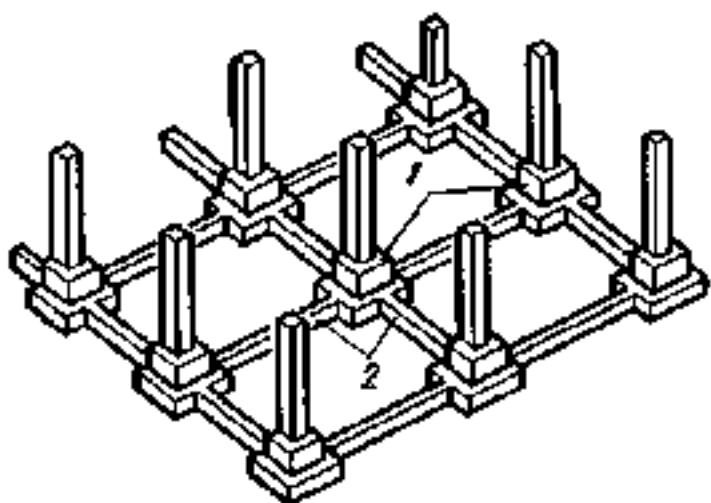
Схема столбчатых фундаментов с антисейсмическими связями:
